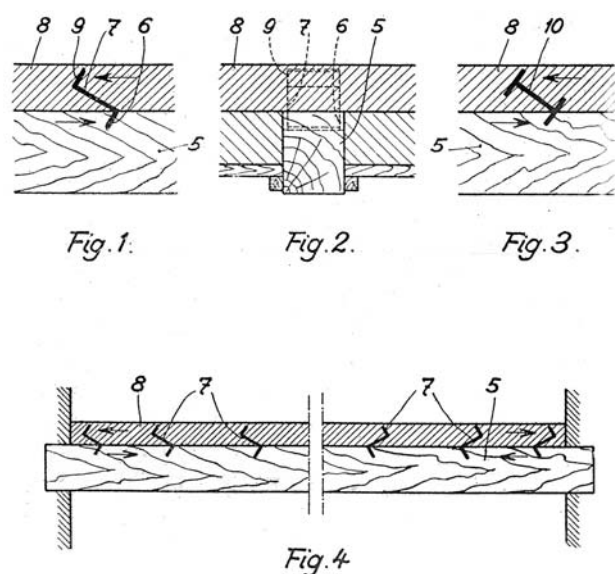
Patentierte Holz-Beton-Verbundlösung aus dem Jahr 1939
